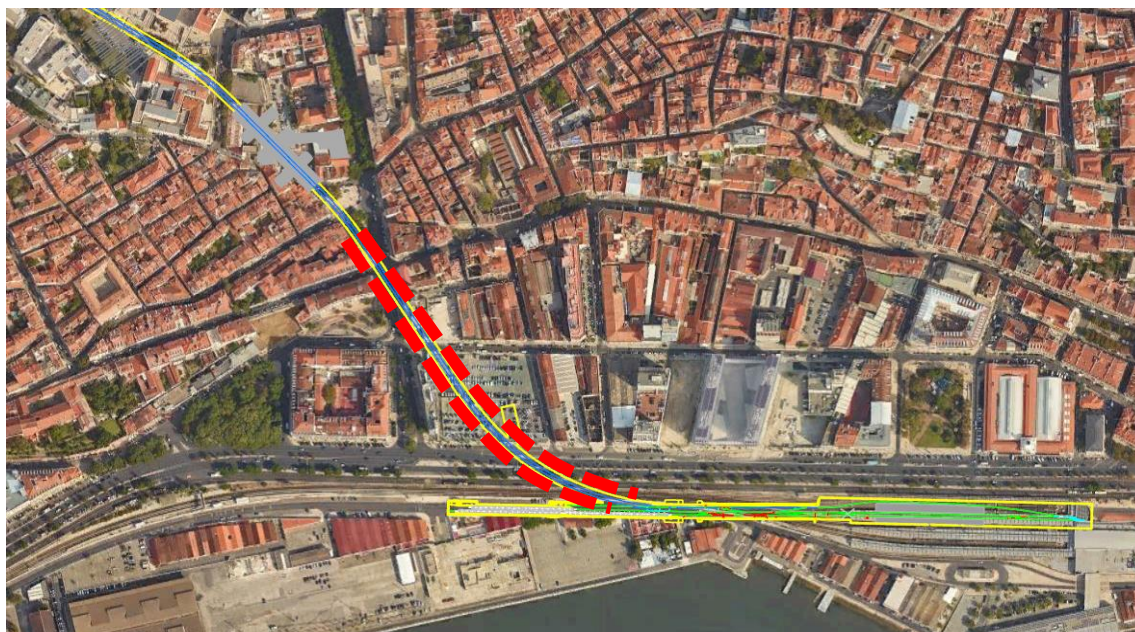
Planta de Implantação do traçado de escavação a céu aberto
